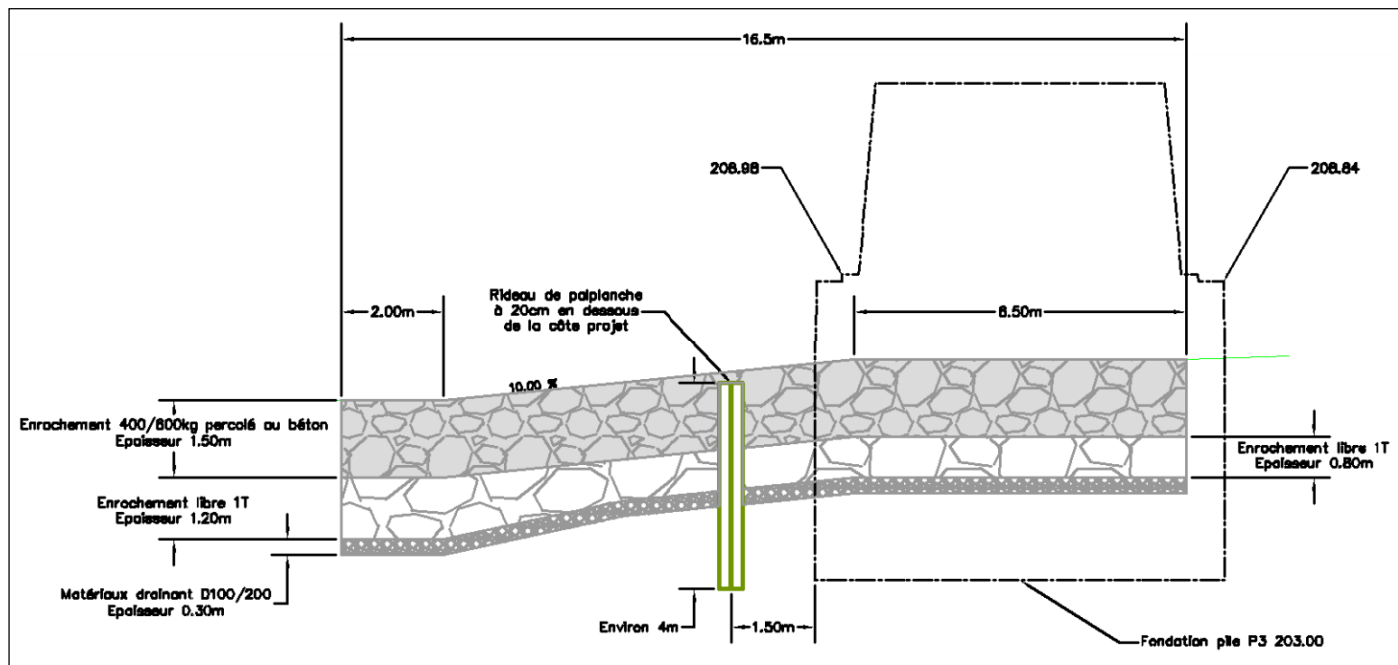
Vue en coupe longitudinale de la rampe à canoë
